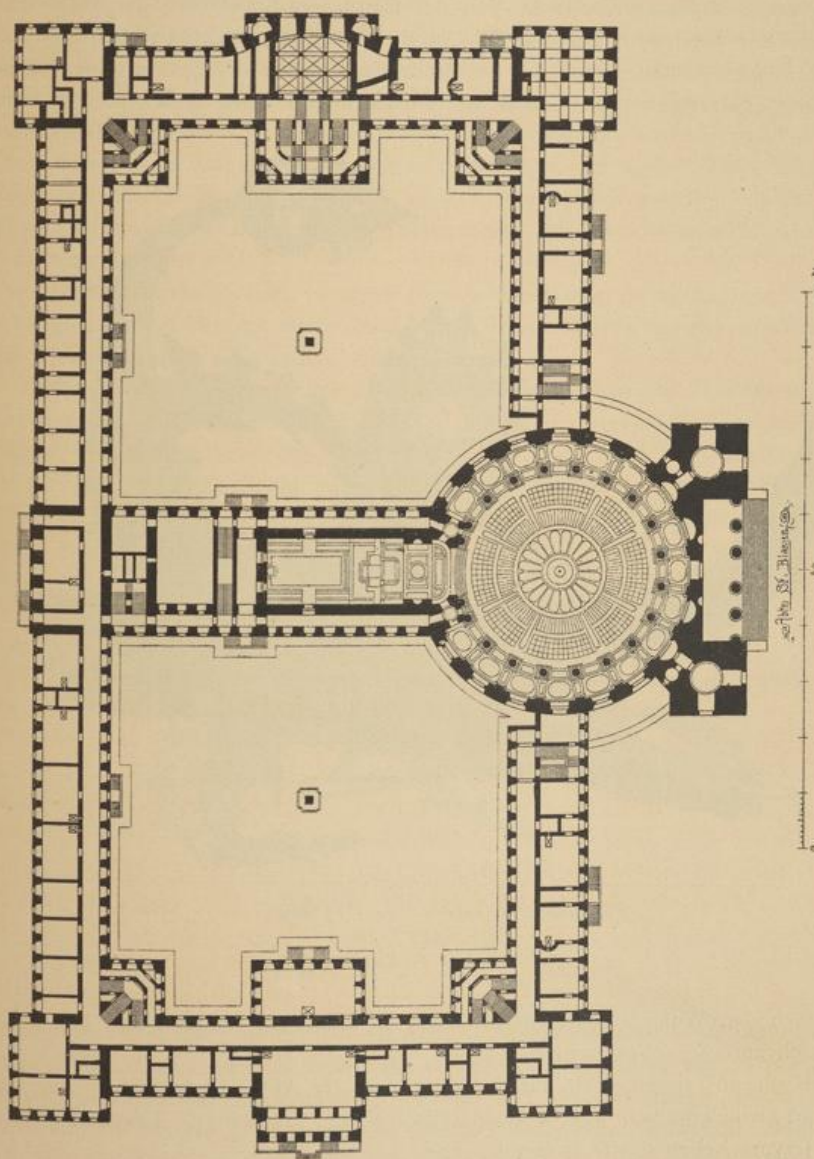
St. Blasien. Grundriss der Abtei S. Blasien (jetziger Bau).
